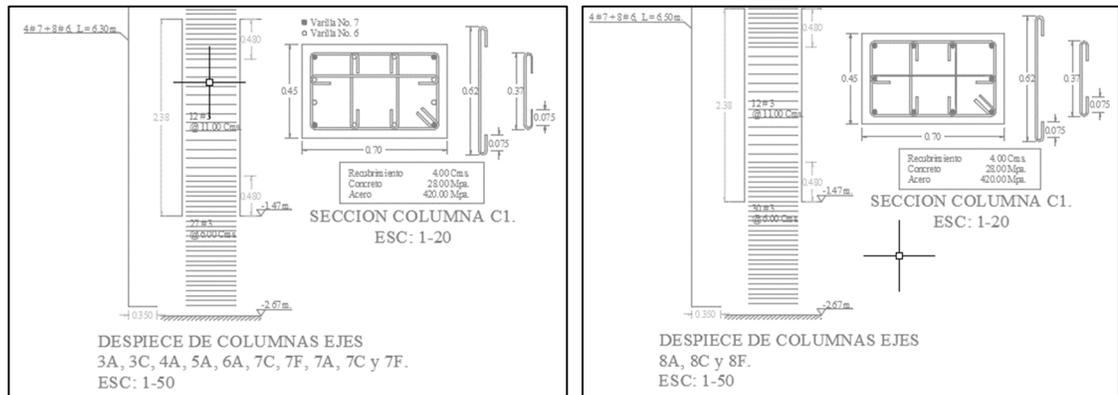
, Columnas 7A, 7C, 7F, 8A, 8C, 8F, Fuente: Constructora Open House.
